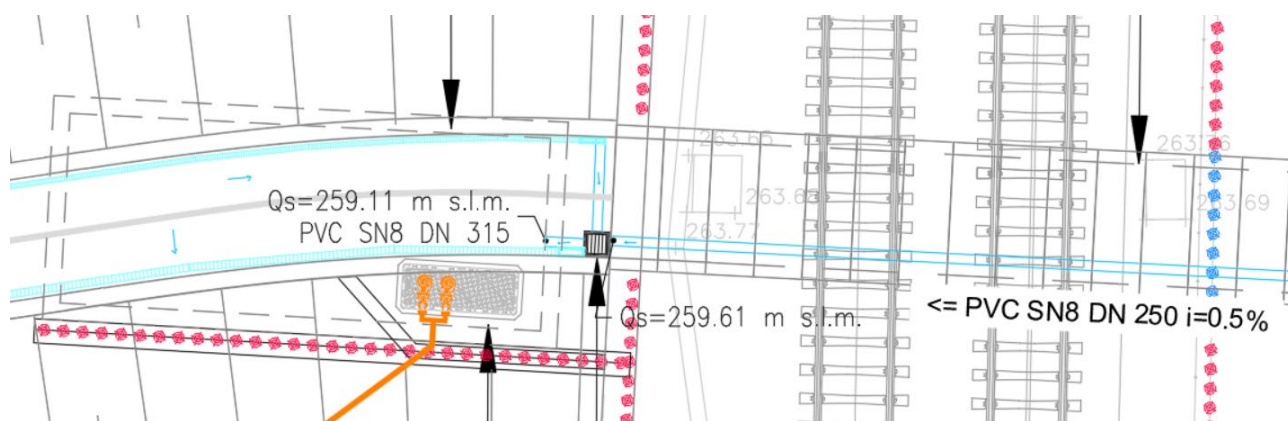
Stralcio planimetrico vasca di laminazione e sottopassaggio
